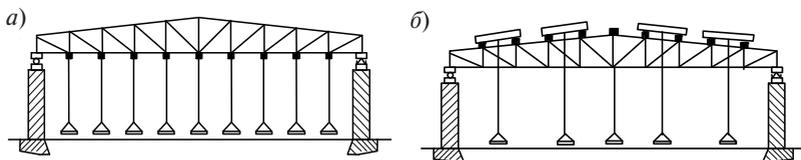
Передача испытательной нагрузки на ферму: *a* — непосредственно на нижние узлы фермы с помощью подвесных платформ; *б* — на верхние узлы фермы с помощью платформ и балок
